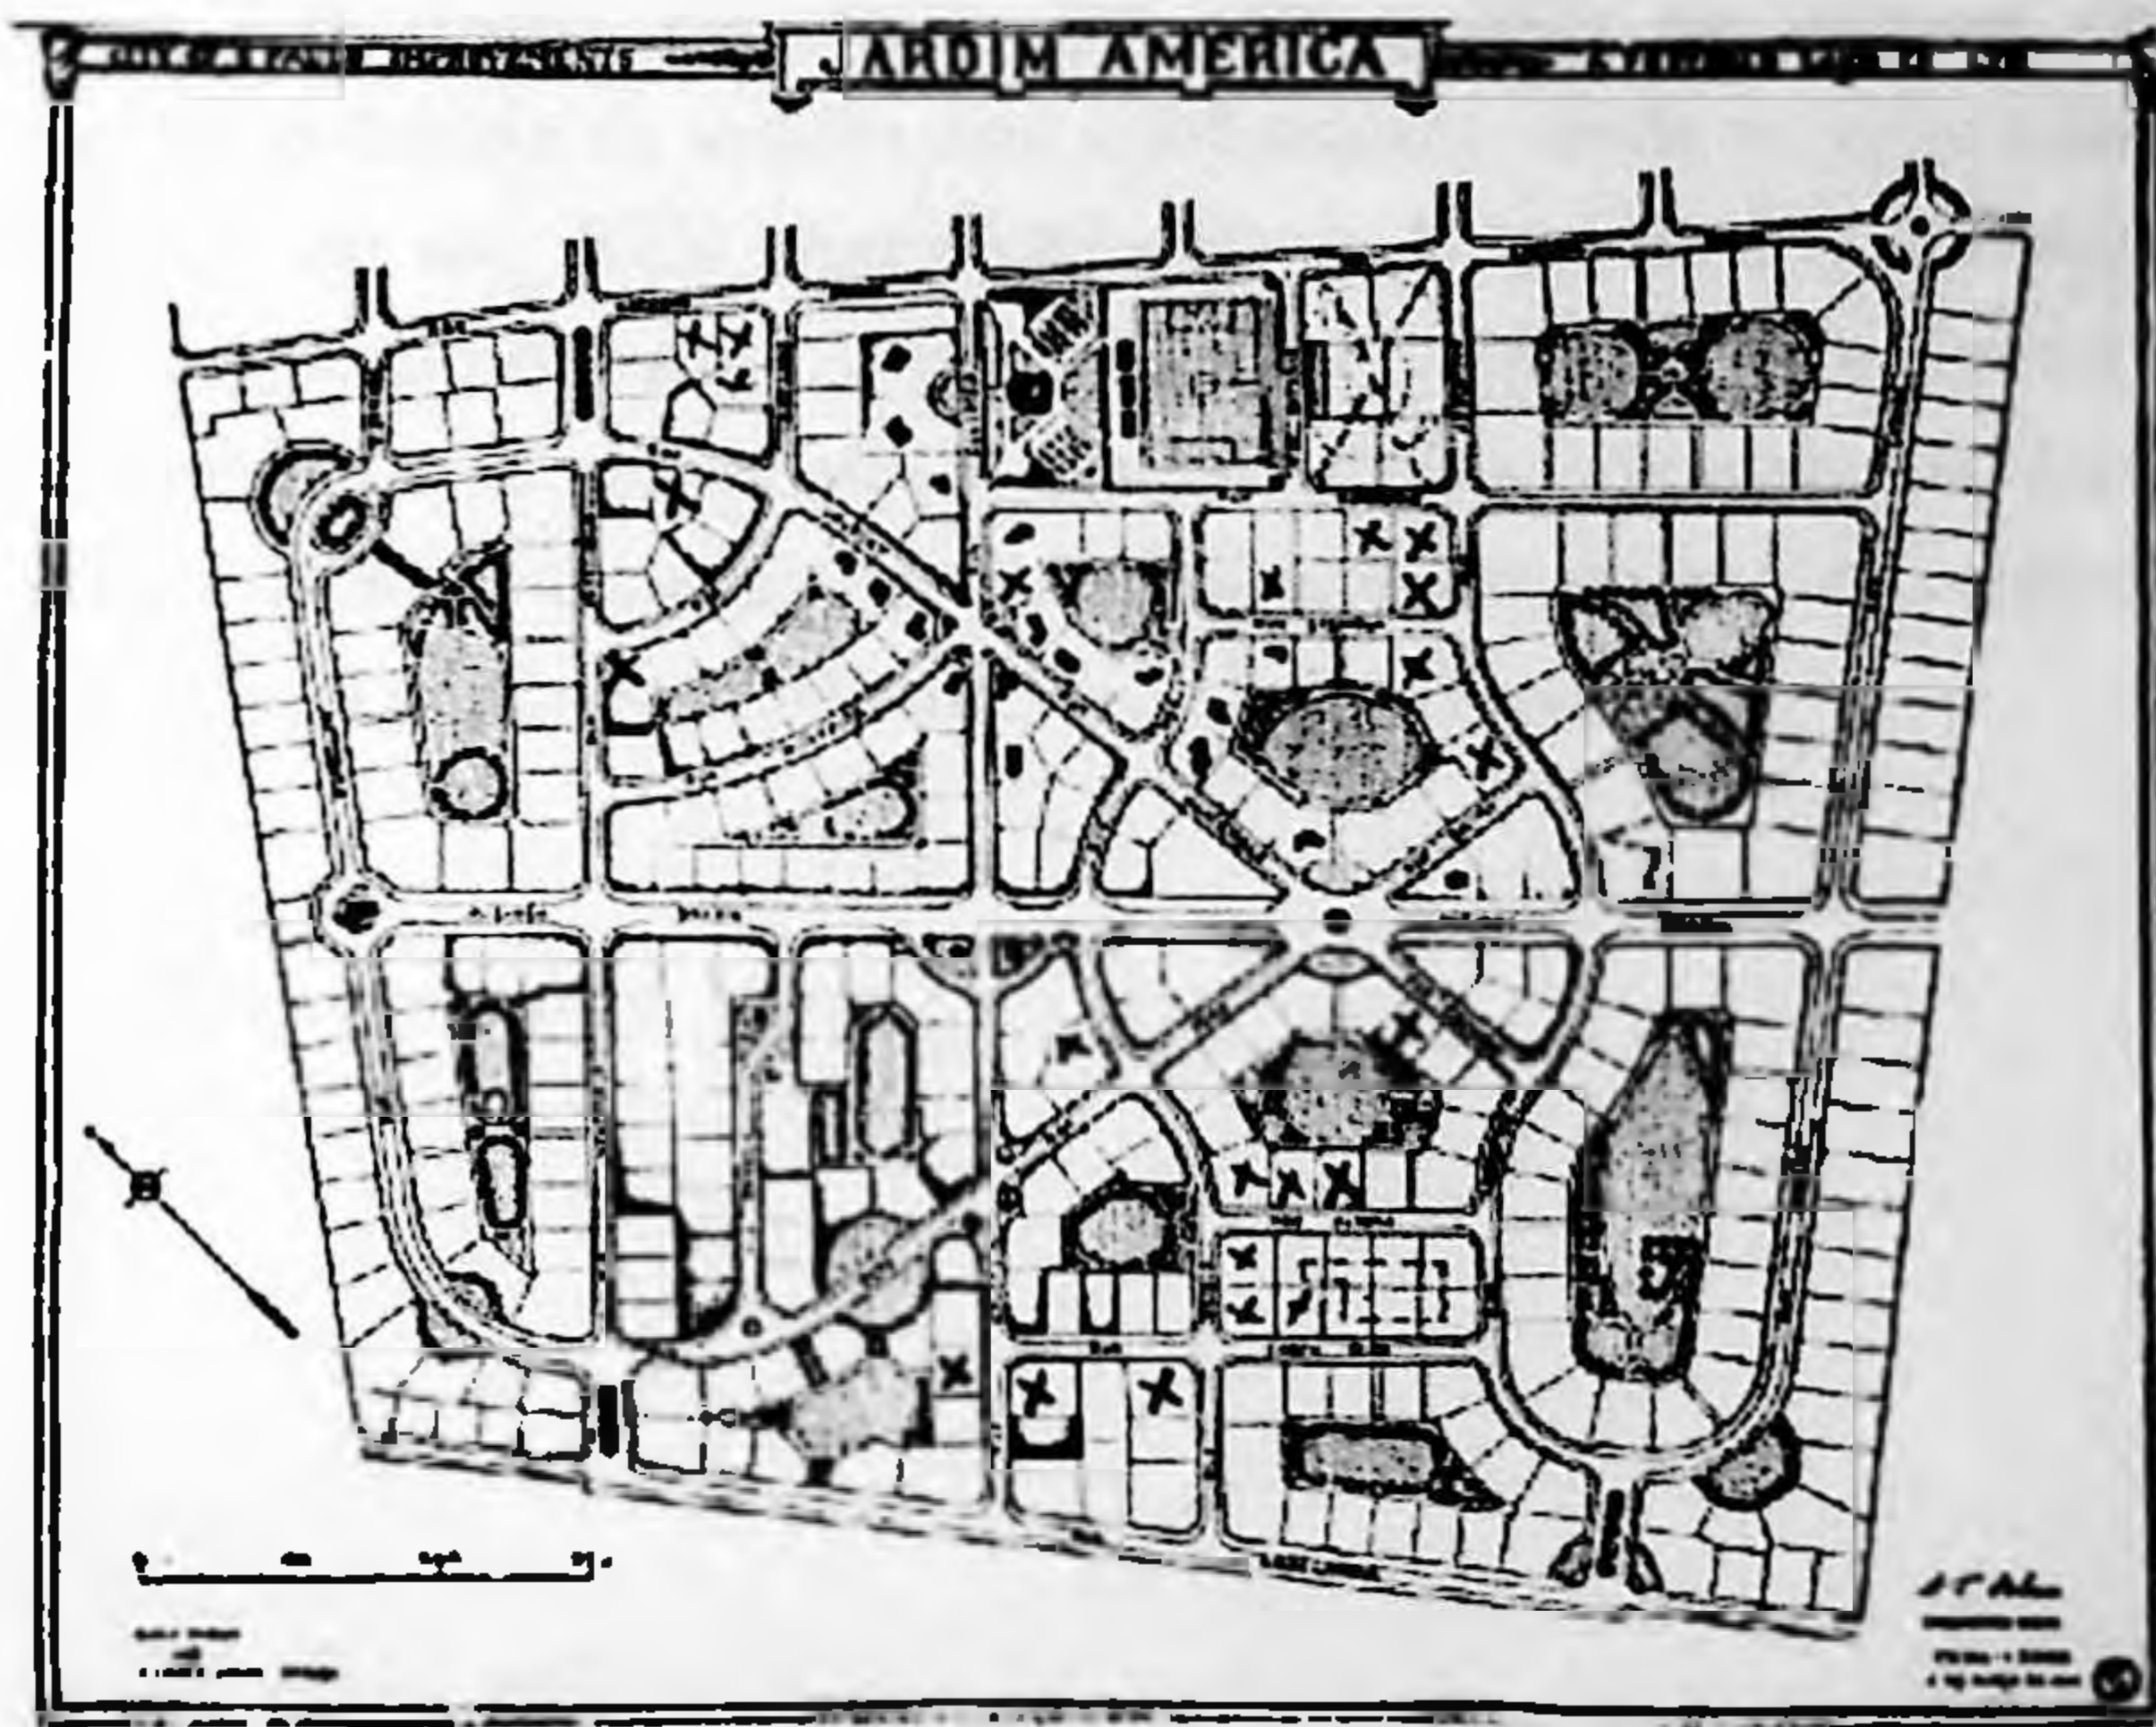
Planta da primeira proposta para o parcelamento do Jardim América, Cia City – SP, 1919.
